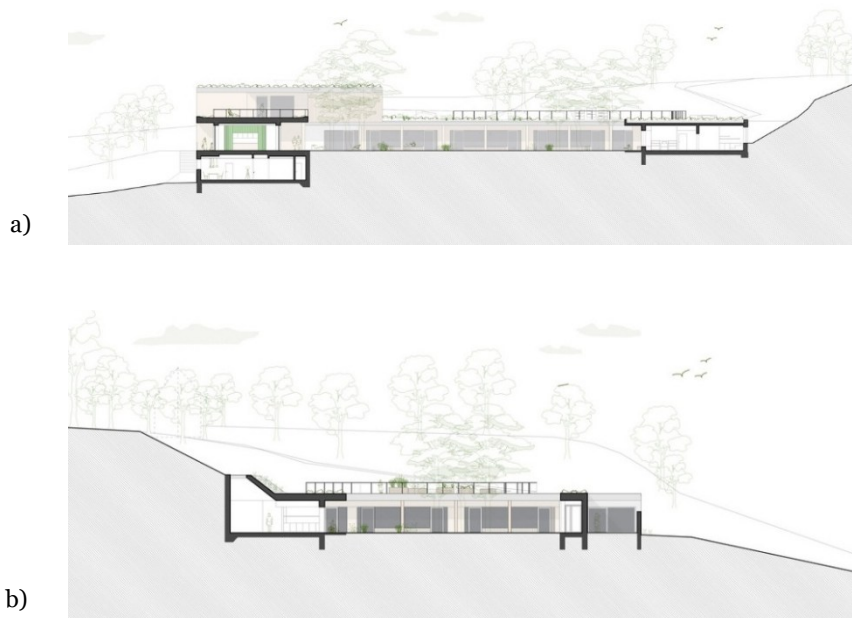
Cortes do edifício (Ctyrsten, 2024): a) corte longitudinal, b) corte transversal
